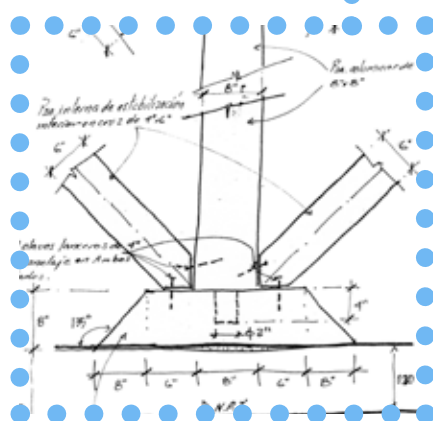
Structure primaire du Taquezal : détail d'assemblage poteaux - contreventements sur fondation (Source : Arch. Daisy Membréño)
